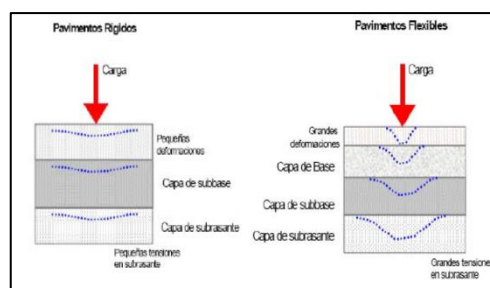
Deterioros en pavimentos flexibles y rígidos Fuente: Ricardo Javier Miranda Rebolledo Valdivia – Chile)
